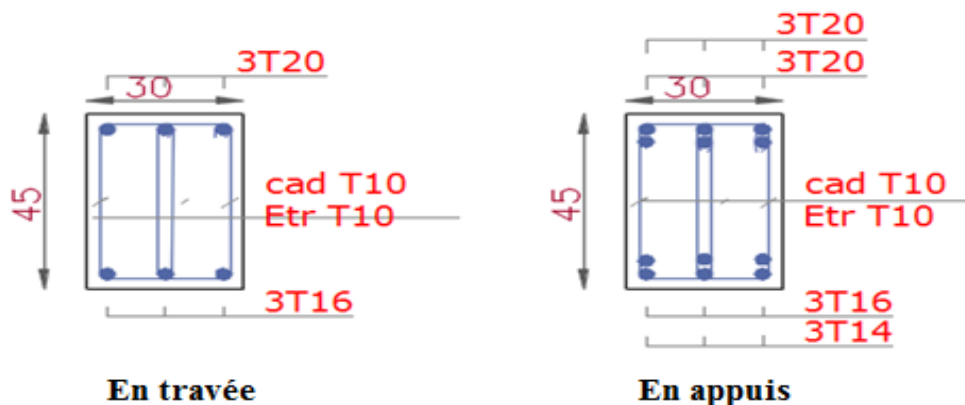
Schéma de ferrailage de poutre (zone 3)
